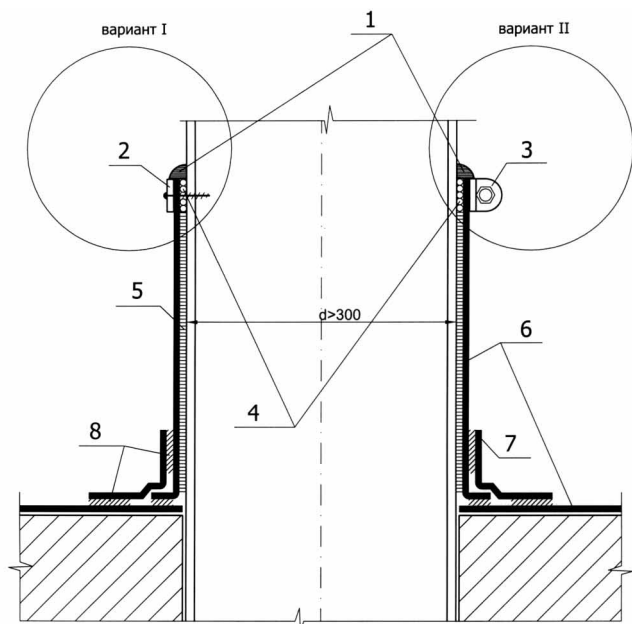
Гидроизоляция трубы диаметром более 300 мм
